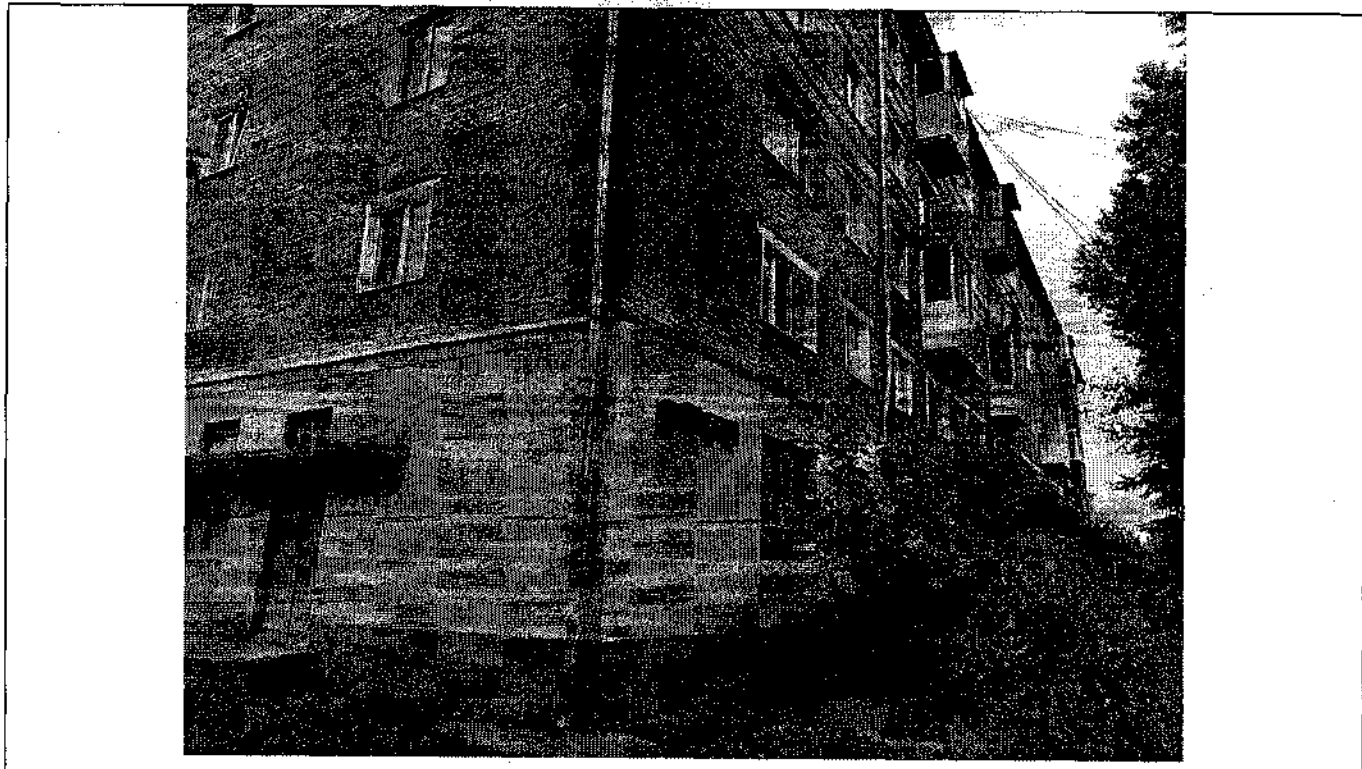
Торцевой фасад со стороны 3-го подъезда. Фасад со стороны ул. Гоголя. Чрезмерное замачивание стен, нарушение окрасочного слоя.
